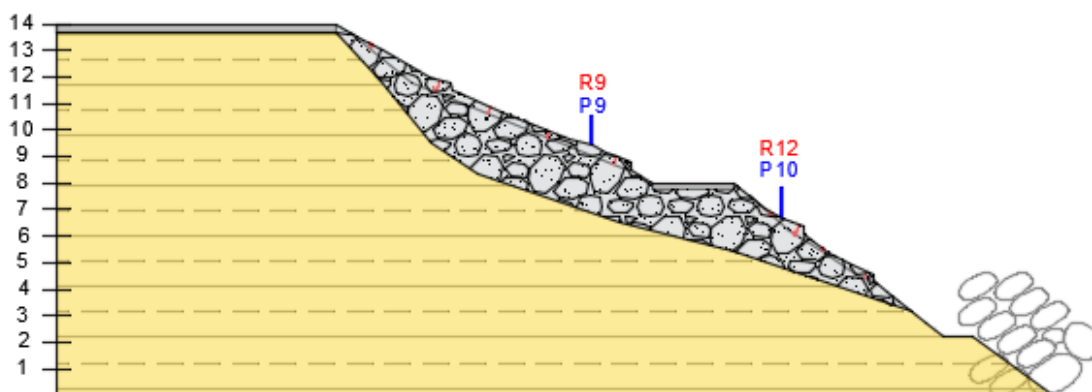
Stralcio sezione geotecnica impiegata nelle analisi di stabilità
